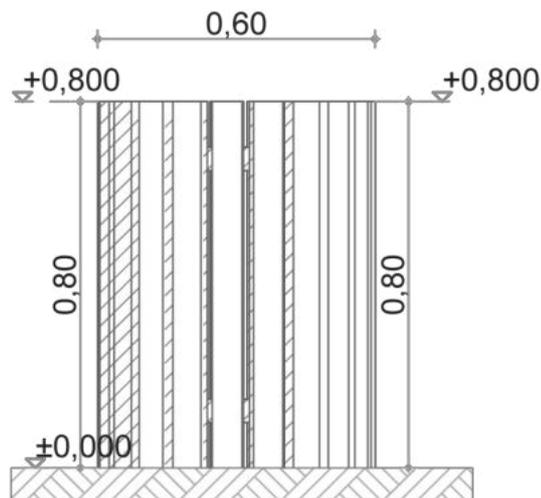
Planos 12 – Alzado de basurero tipo 2. Fuente: Elaboración propia Nota: Elevación frontal con sus respectivas medidas
